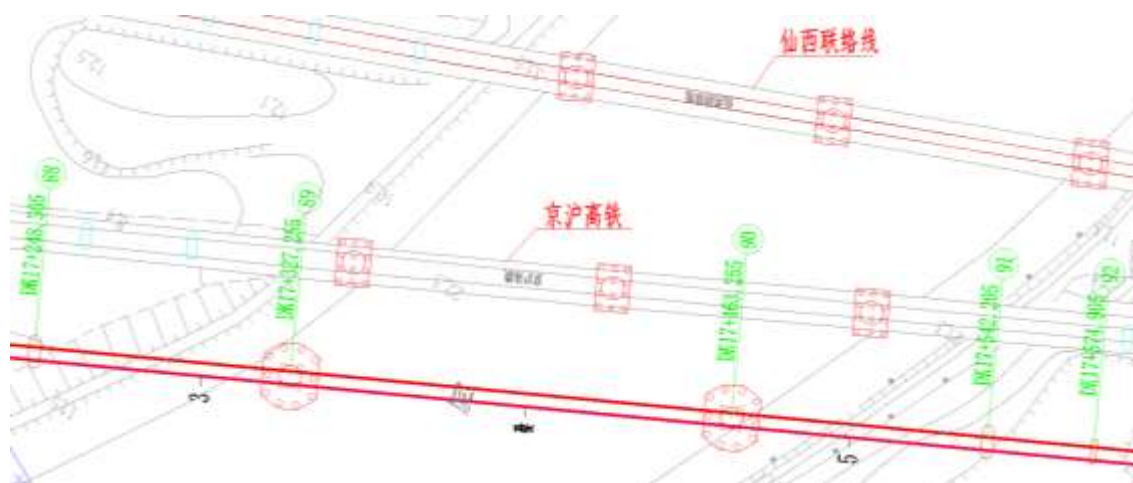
秦淮河特大桥跨河处平面布置图
